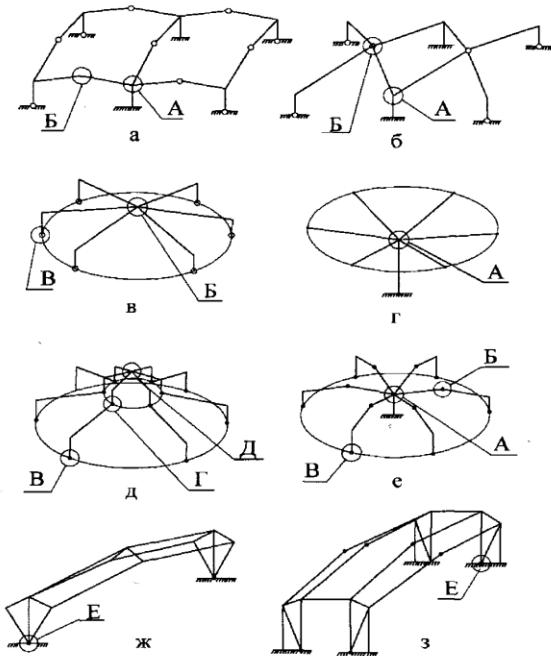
Конструктивні схеми каркасів споруд із залізобетонних рам:
